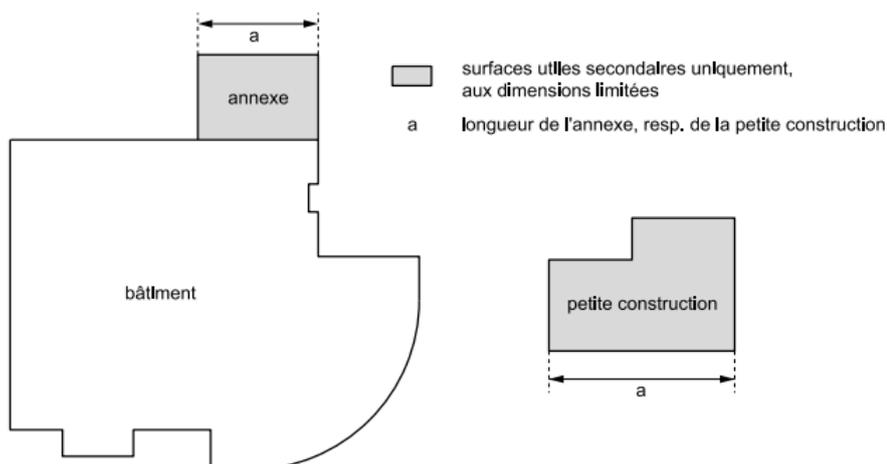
2.3 Bâtiments, petites constructions et annexes
